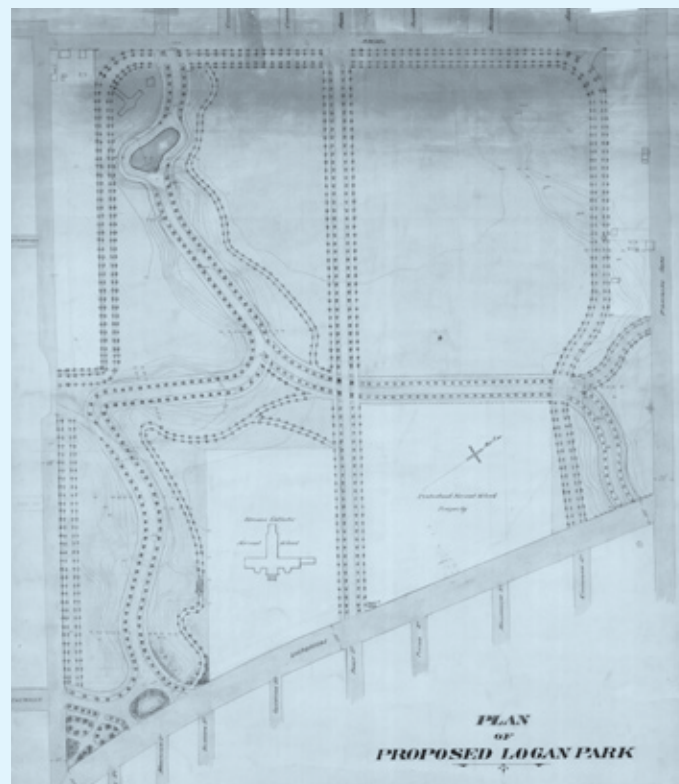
Plan du parc Logan, *Plan of proposed Logan park*, Mai 1889.
